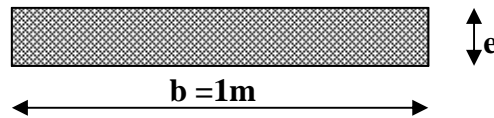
Section de la dalle pleine 'c' à ferrailer
